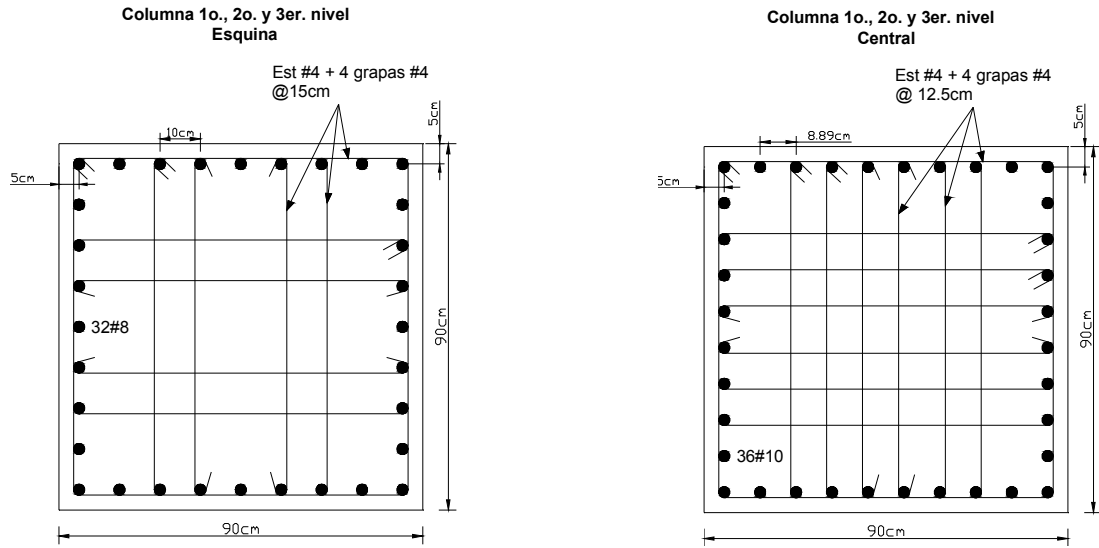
Detallado de estribos en los extremos de las columnas, niveles 1, 2 y 3
